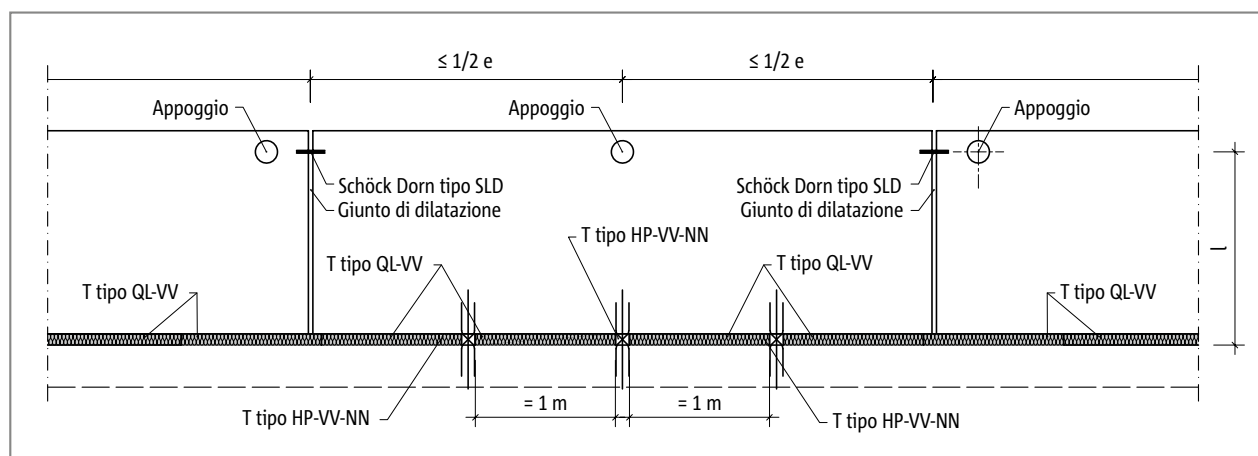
Schöck Isokorb® T tipo HP: disposizione dei giunti di dilatazione
